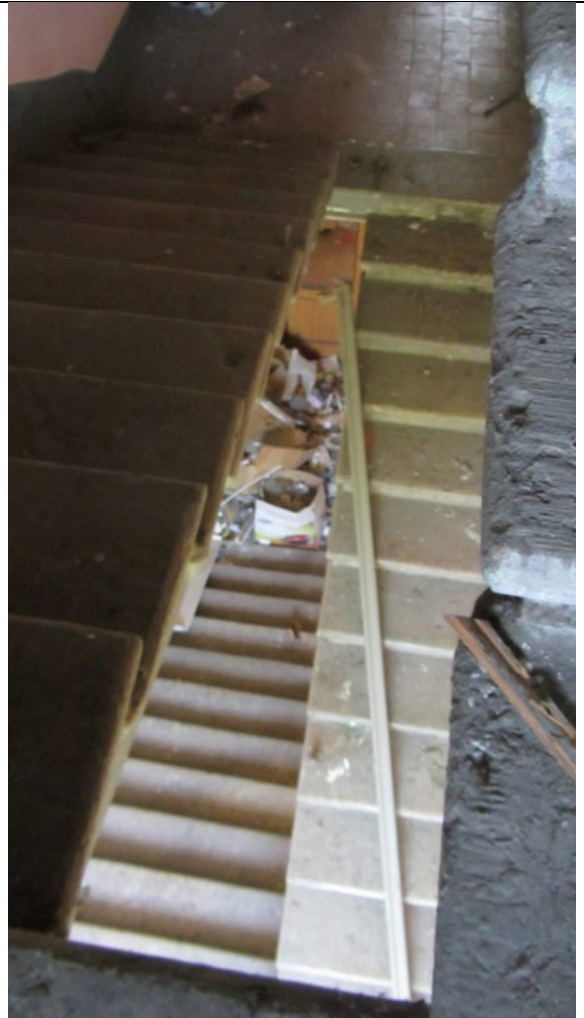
Подход к пом. 1 н.ч. по лестнице №2
